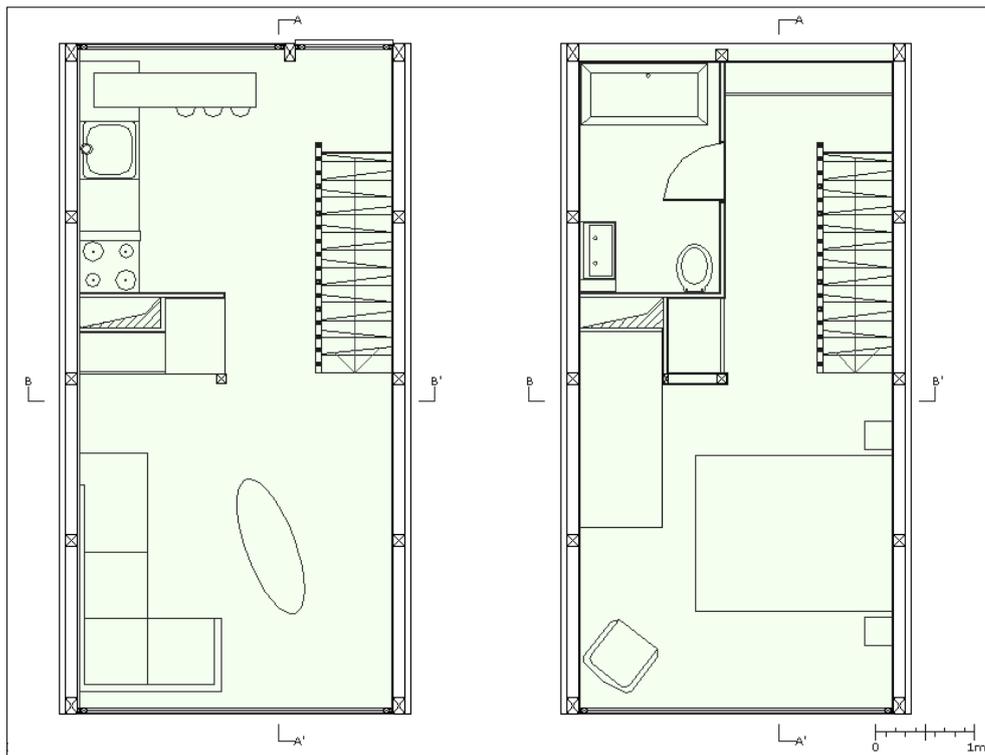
Planta da proposta da tipologia 1. Esquerda (cota +3.20) e direita (piso térreo)
